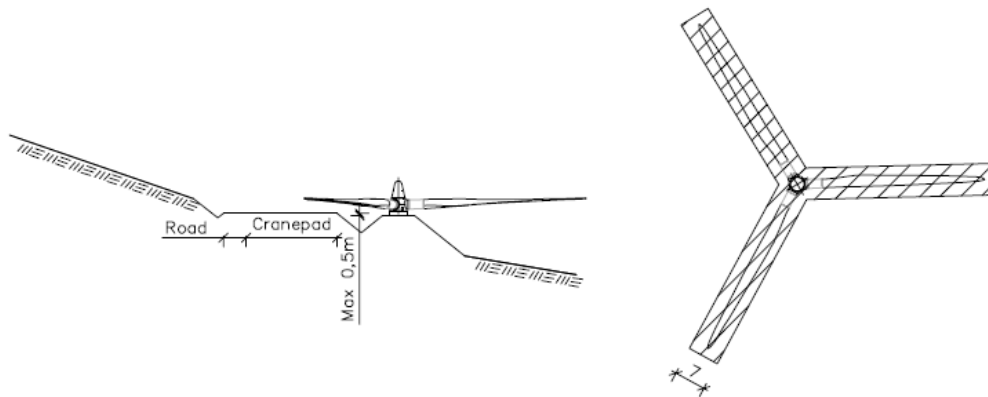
Perfil y planta de un área típica de ensamble para aspas (perfil/planta). EL área achurada en el lado derecho debe estar libre de obstáculos y tener un gradiente no mayor a 1:30
